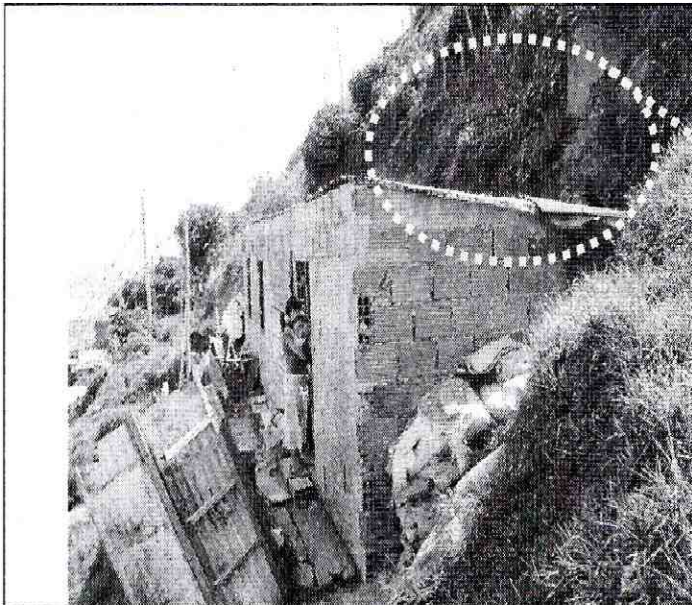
Vista de la vivienda emplazada en el predio evaluado.
